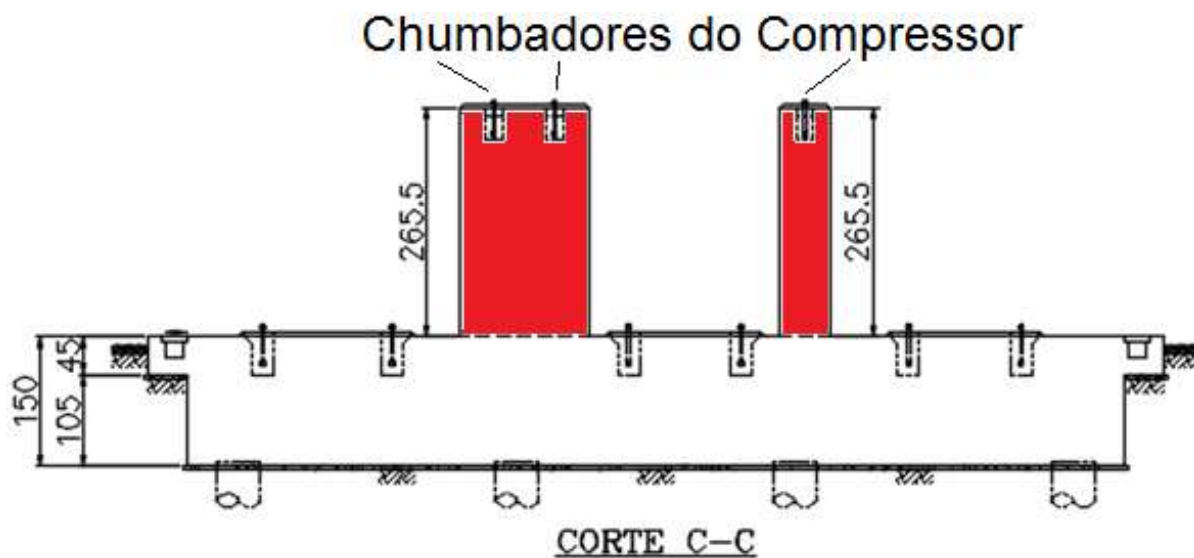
Modelo estrutural: elevação da fundação (Corte C-C) [3].
